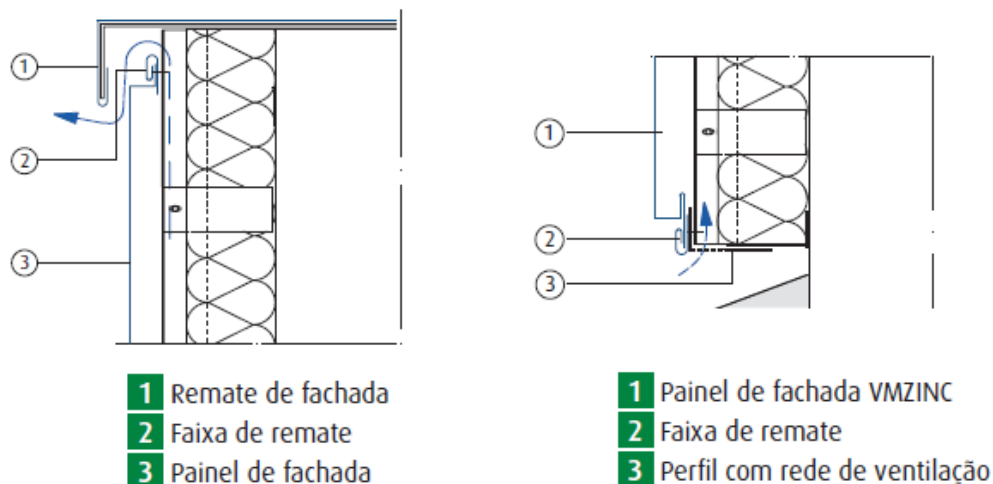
Execução da parte alta e da parte baixa da fachada, respetivamente [6]
